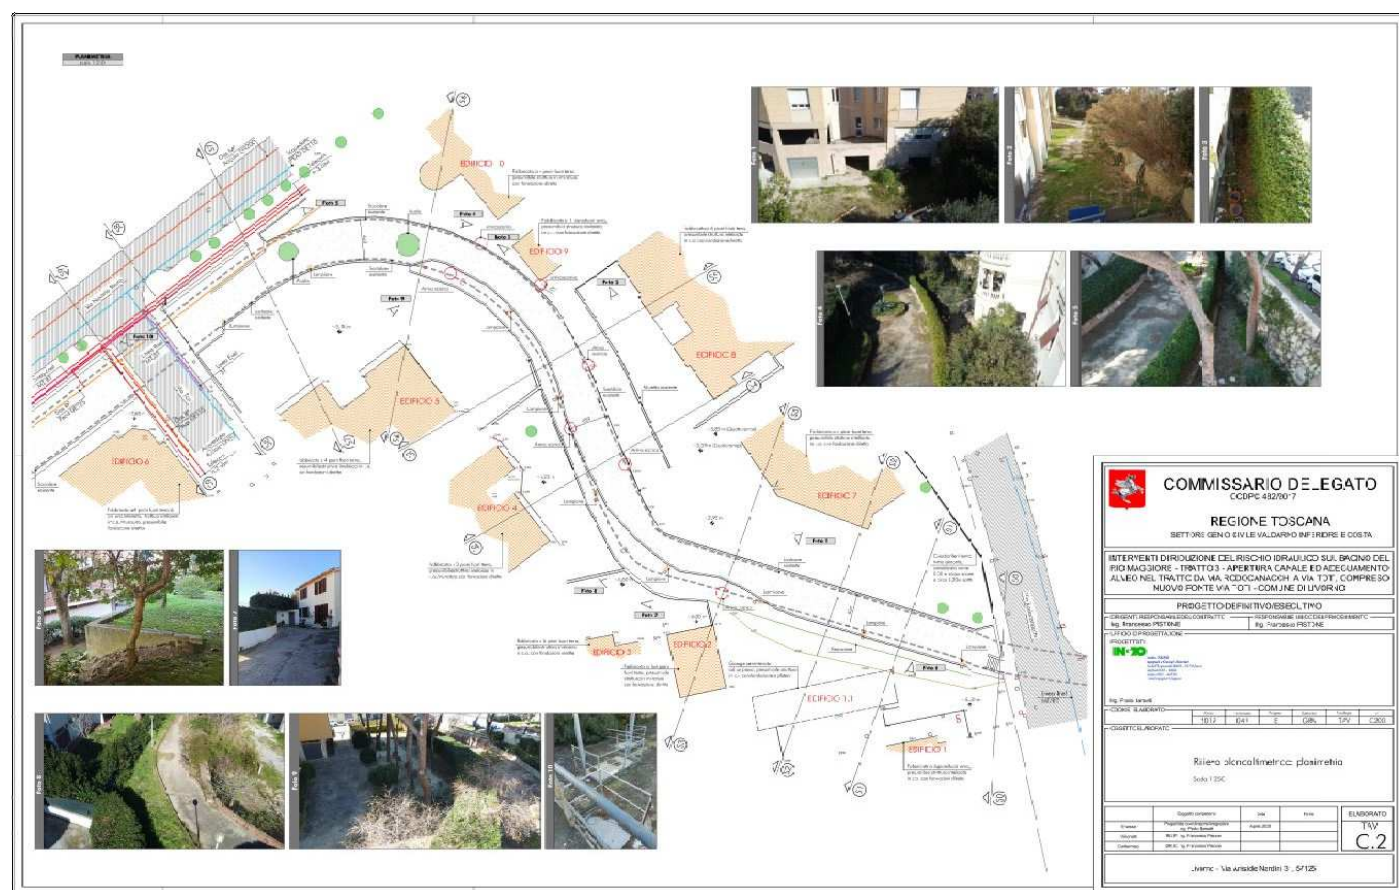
Estratto TAV. C.2 Rilievo planoaltimetrico: planimetria
